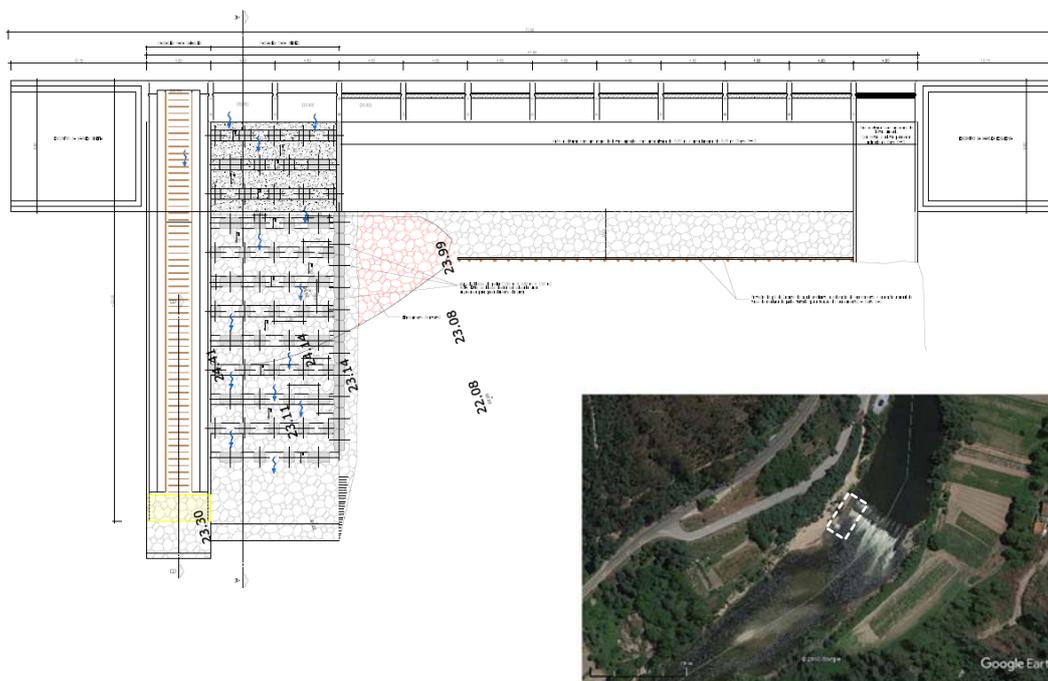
Rampas para peixes e para caiaques do açude de Louredo, vista em planta. Vista área com o local da intervenção assinalado.
